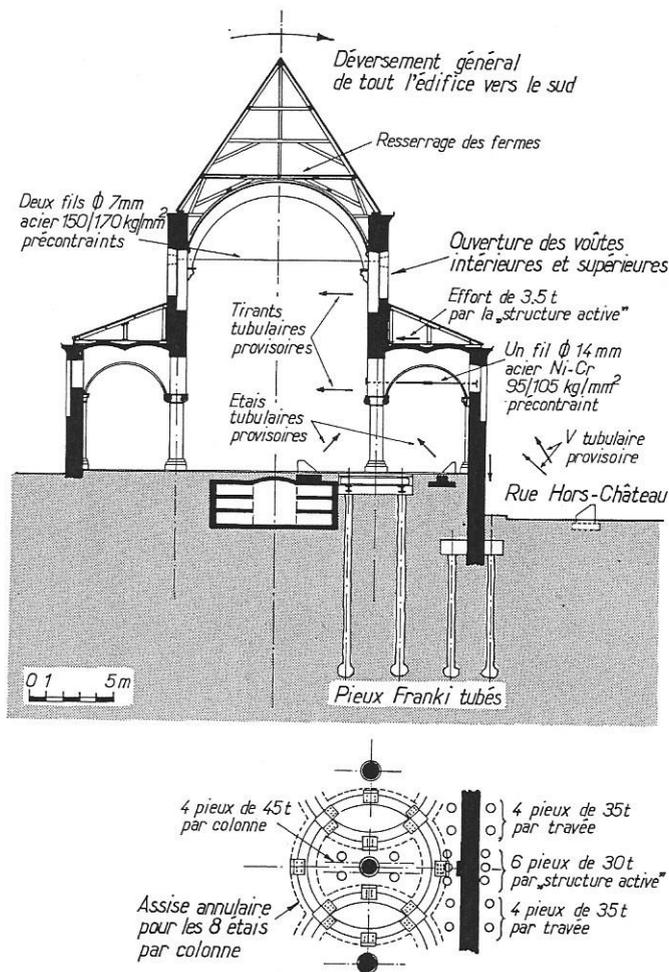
et 8. — COUPE VERTICALE TRANSVERSALE ET PLAN DE DÉTAIL PARTIEL montrant les dispositions adoptées pour les travaux de restauration et de reprise en sous-œuvre.
